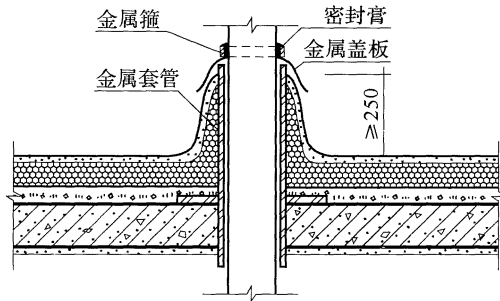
喷涂硬泡聚氨酯屋面伸出屋面管道防水构造
